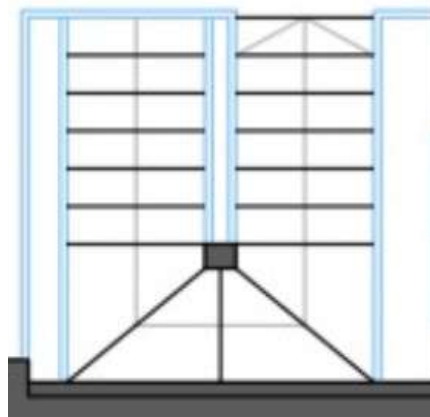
Planta de la escalera en proyecto (proyecto básico)
